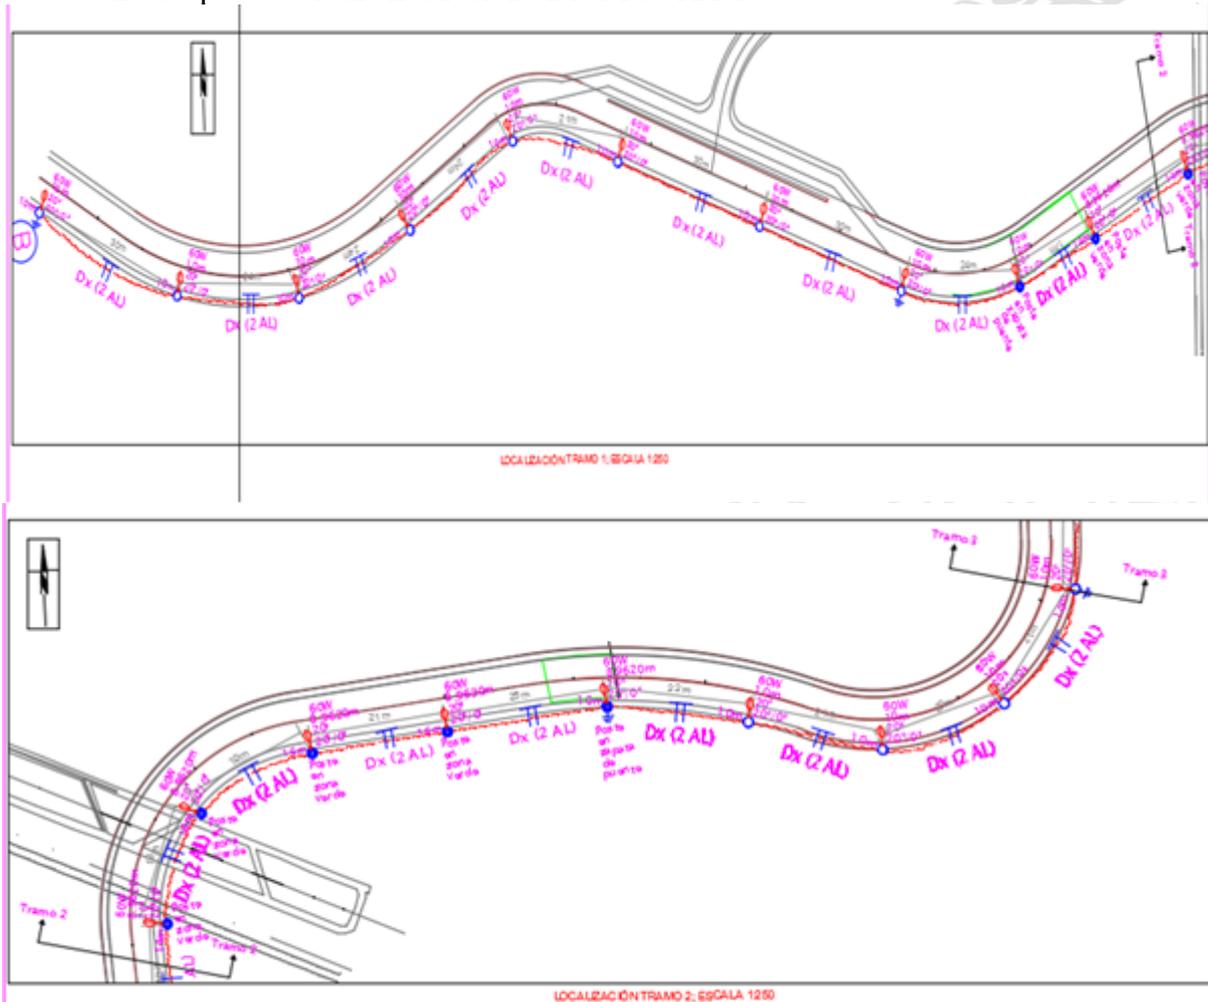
Planos detallados de Alumbrado público realizado AutoCAD 2D.
